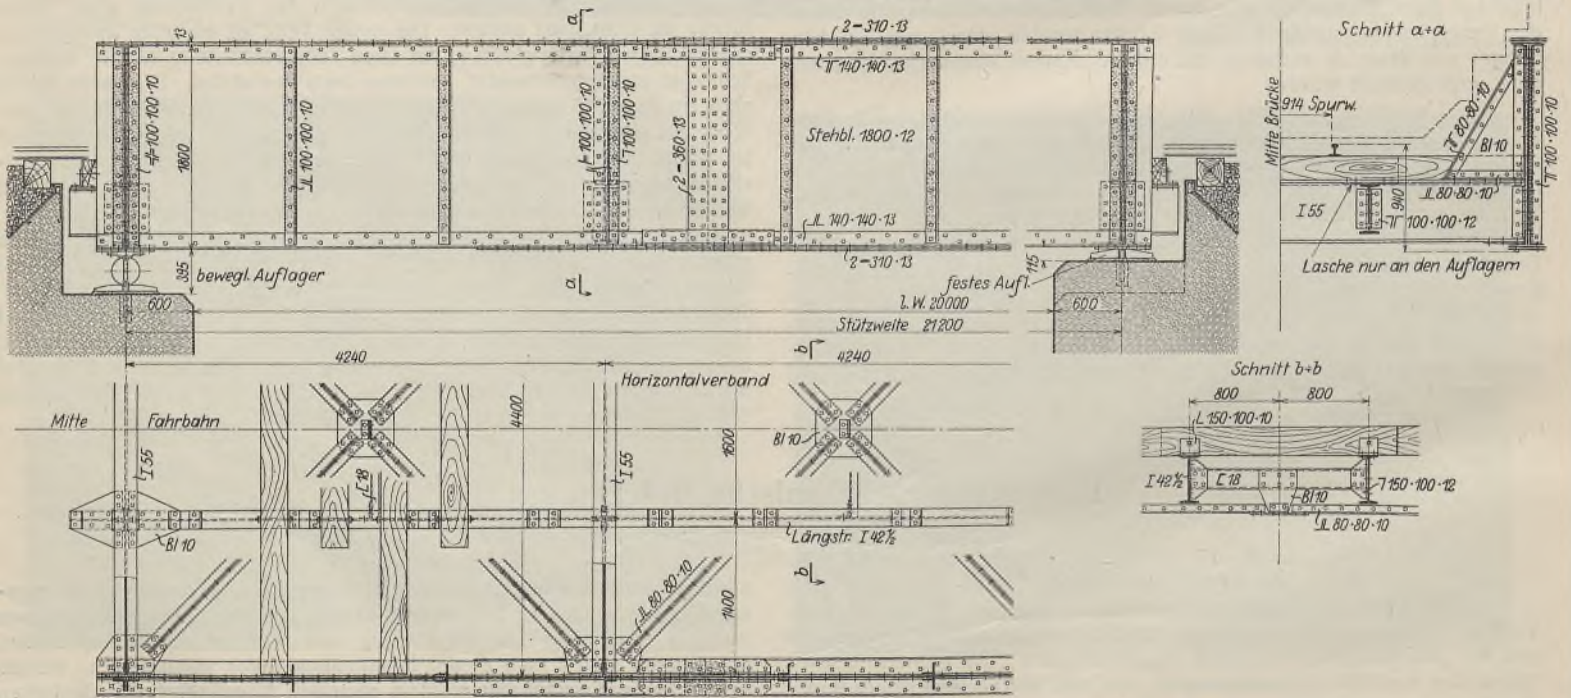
Eisenbahnbrücke mit beschränkter Bauhöhe.
